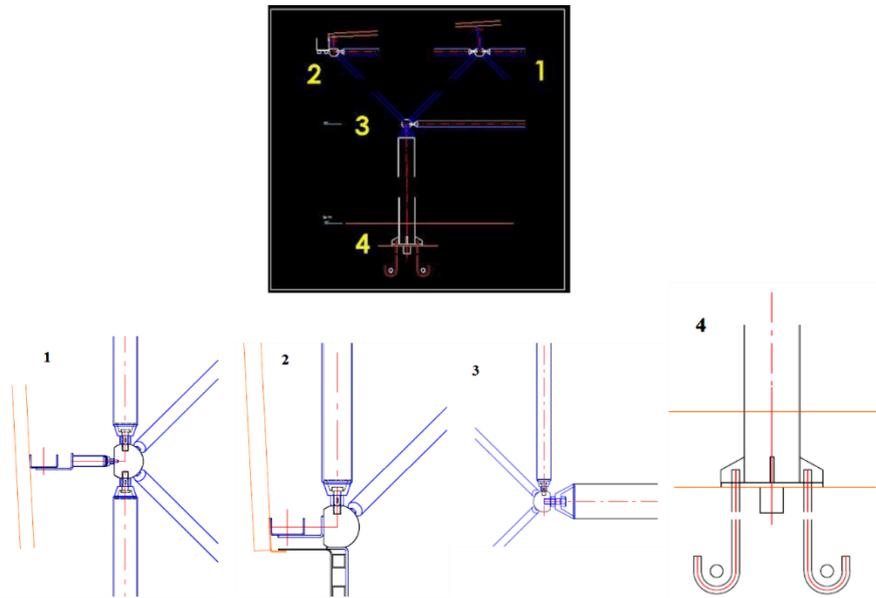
Les détails de construction de la structure tridimensionnelle¹⁹³
